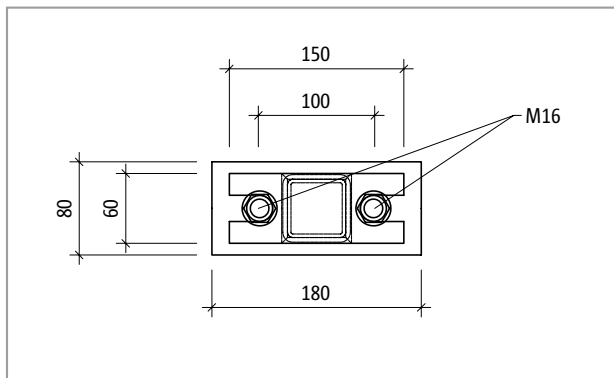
Schöck Isokorb® T type S-V-D16: Elevation of the product
